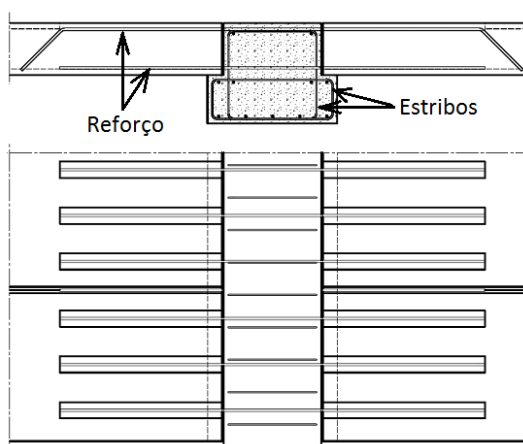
Ligação laje-viga. Adaptado: Fib (2014).
